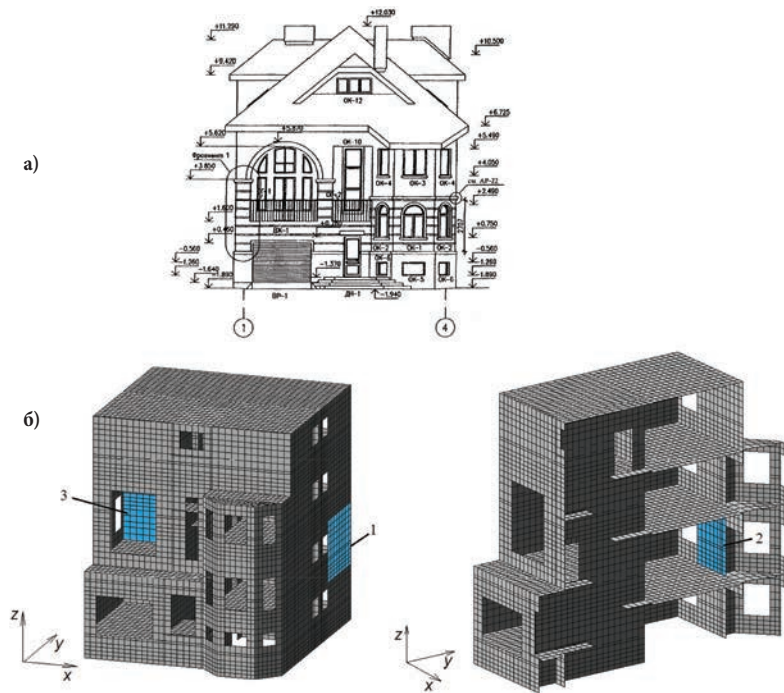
Фасад жилого дома с несущими стенами из газобетонных блоков (а) и пространственная модель здания (б).
